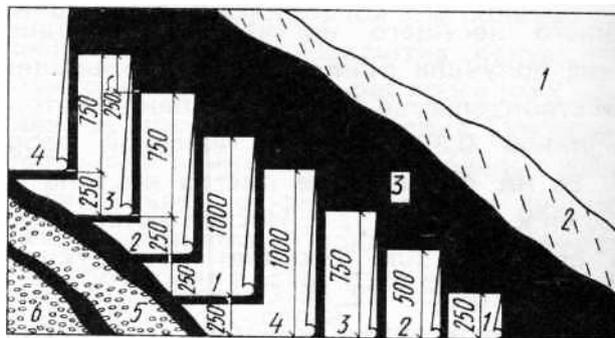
Пример раскладки полотнищ гидроизоляционного ковра плоской кровли:
